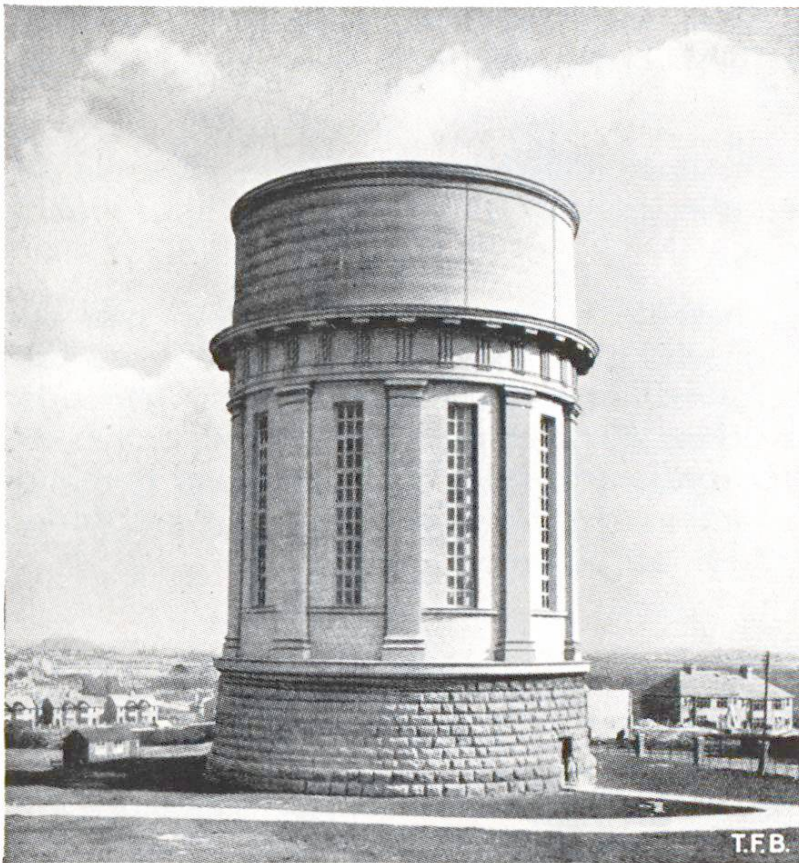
Wasserturm in Blackpool, vollständig aus Beton und Eisenbeton errichtet. Der Fuss ist aus gespaltenen Betonsteinen. Architekt A. C. Dickie, M. A. (aus Concrete Craft, C. C. A. London)
